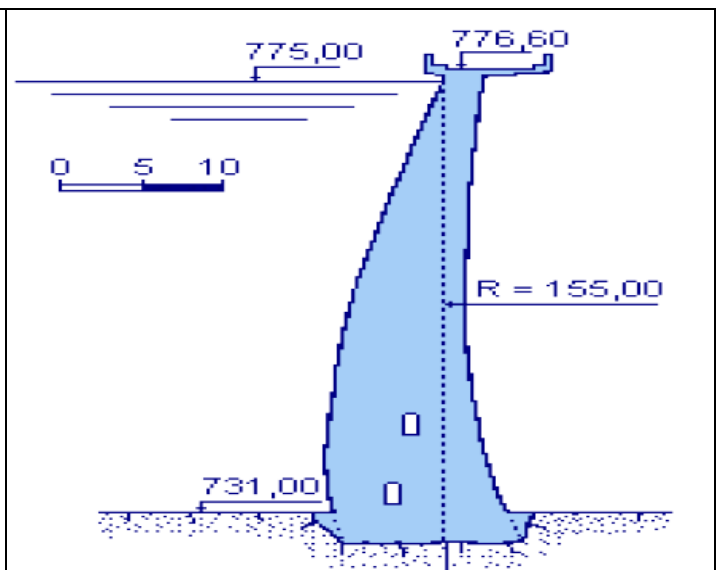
Coupe verticale d'un barrage voûte. [SIT]
